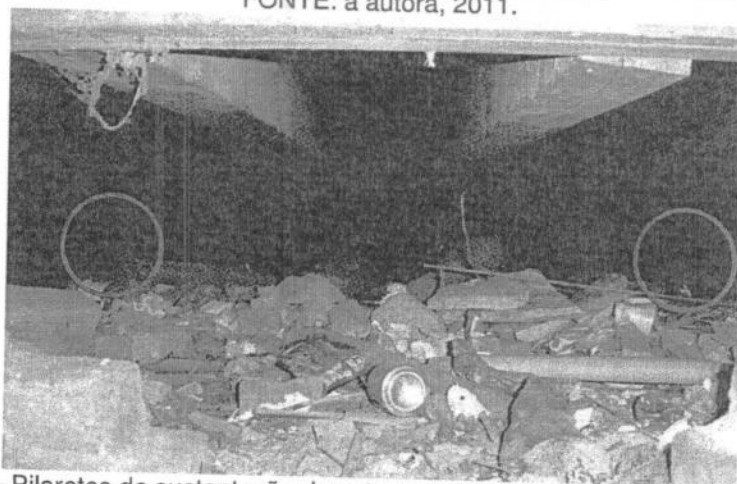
Pilaretes de sustentação da estrutura do piso na metade direita do prédio.
